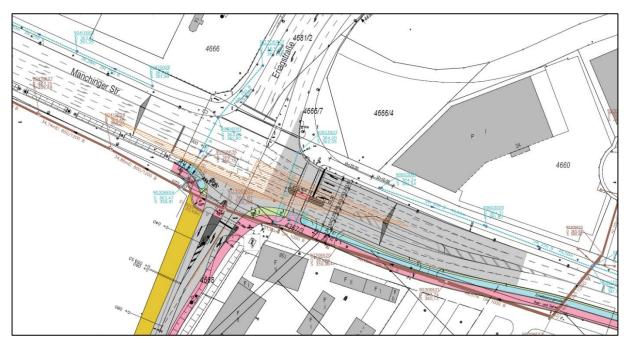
Lageplanausschnitt LSA F9 (K1)
